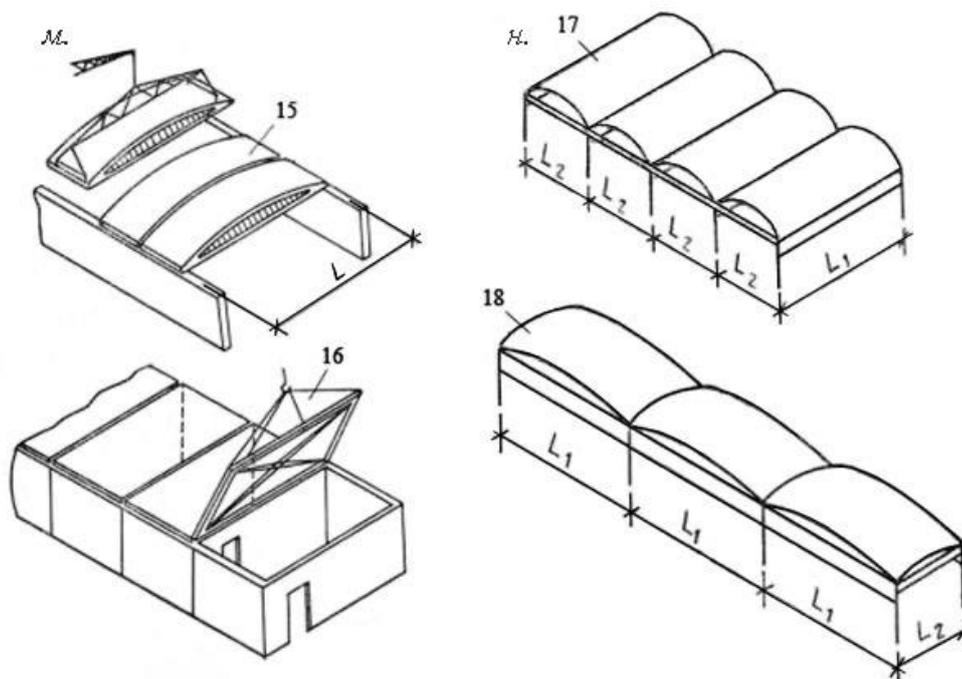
Схемы тонкостенных железобетонных пространственных конструкций покрытий и перекрытий
